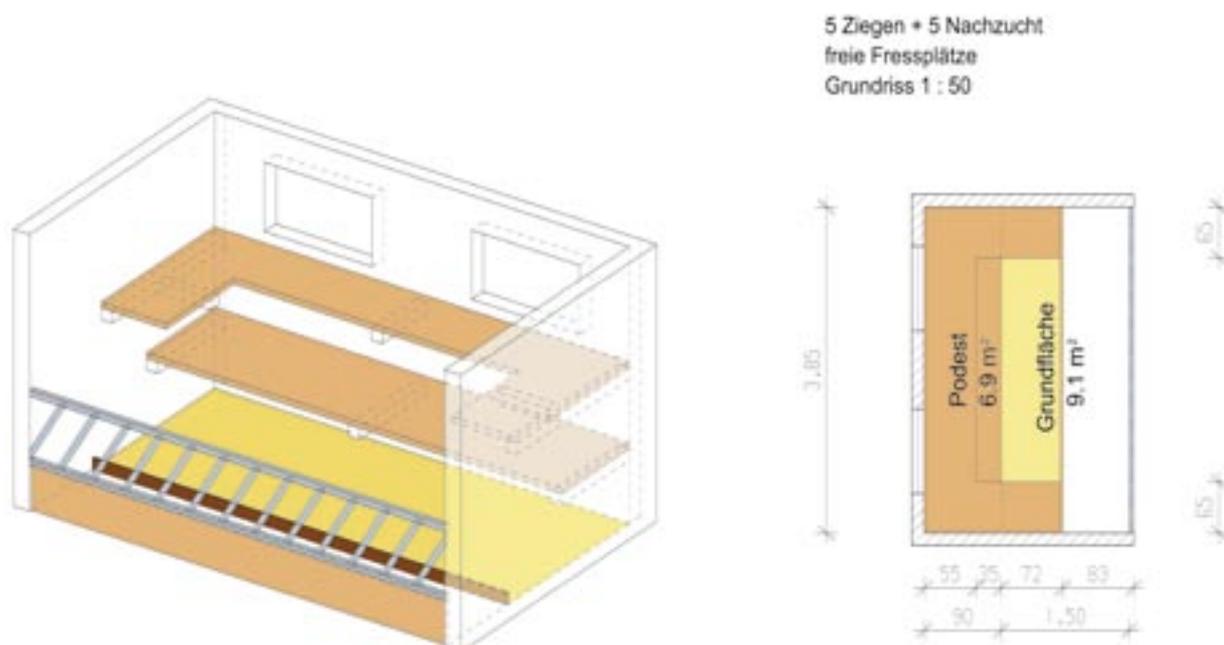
a und b: Modellstall für 10 Ziegen mit Nachzucht (5 erwachsene Ziegen und 5 Jungtiere), Perspektive (a) und Grundriss (b) mit Vermassung.
